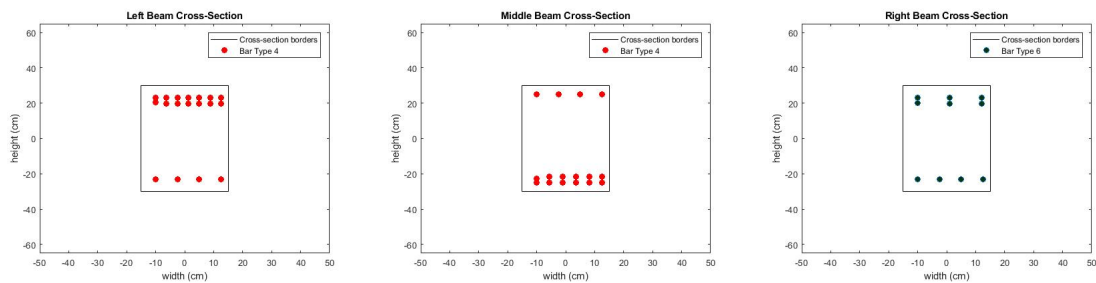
Diseños de las tres secciones principales de concreto reforzado en el elemento viga (izq., centro, der.), respectivamente.
